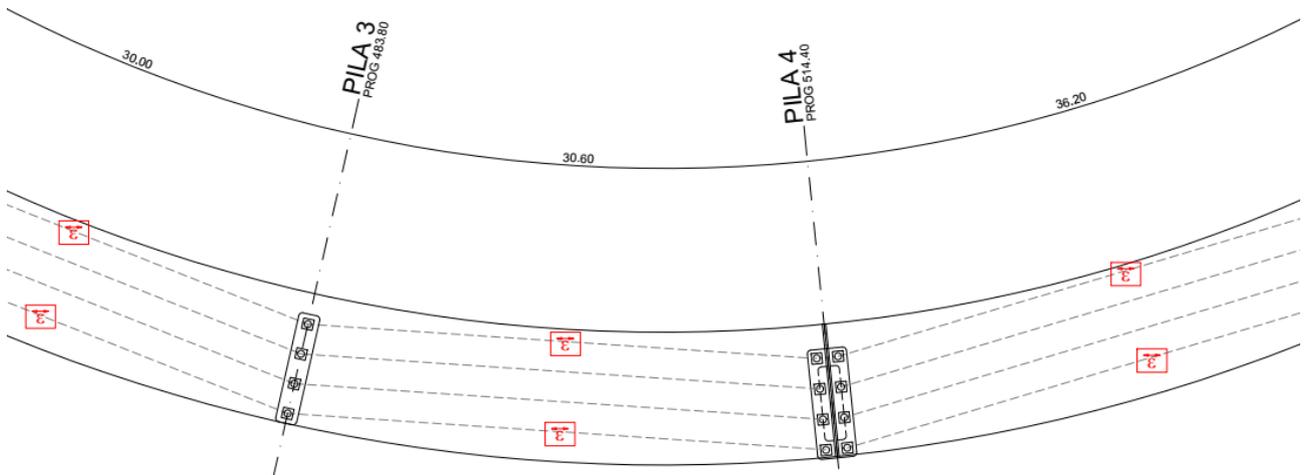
Ubicazione sensori su impalcato sezione a 3 travi (Pianta viadotto MdP)
